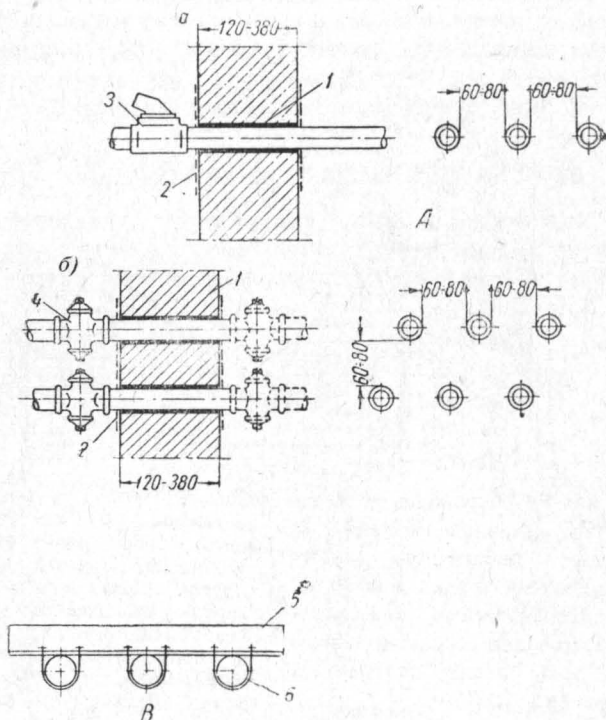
Проходы трубопроводов из взрывоопасных помещений одного класса во взрывоопасные помещения другого класса (или другой среды) или в помещения невзрывоопасные или наружу:
